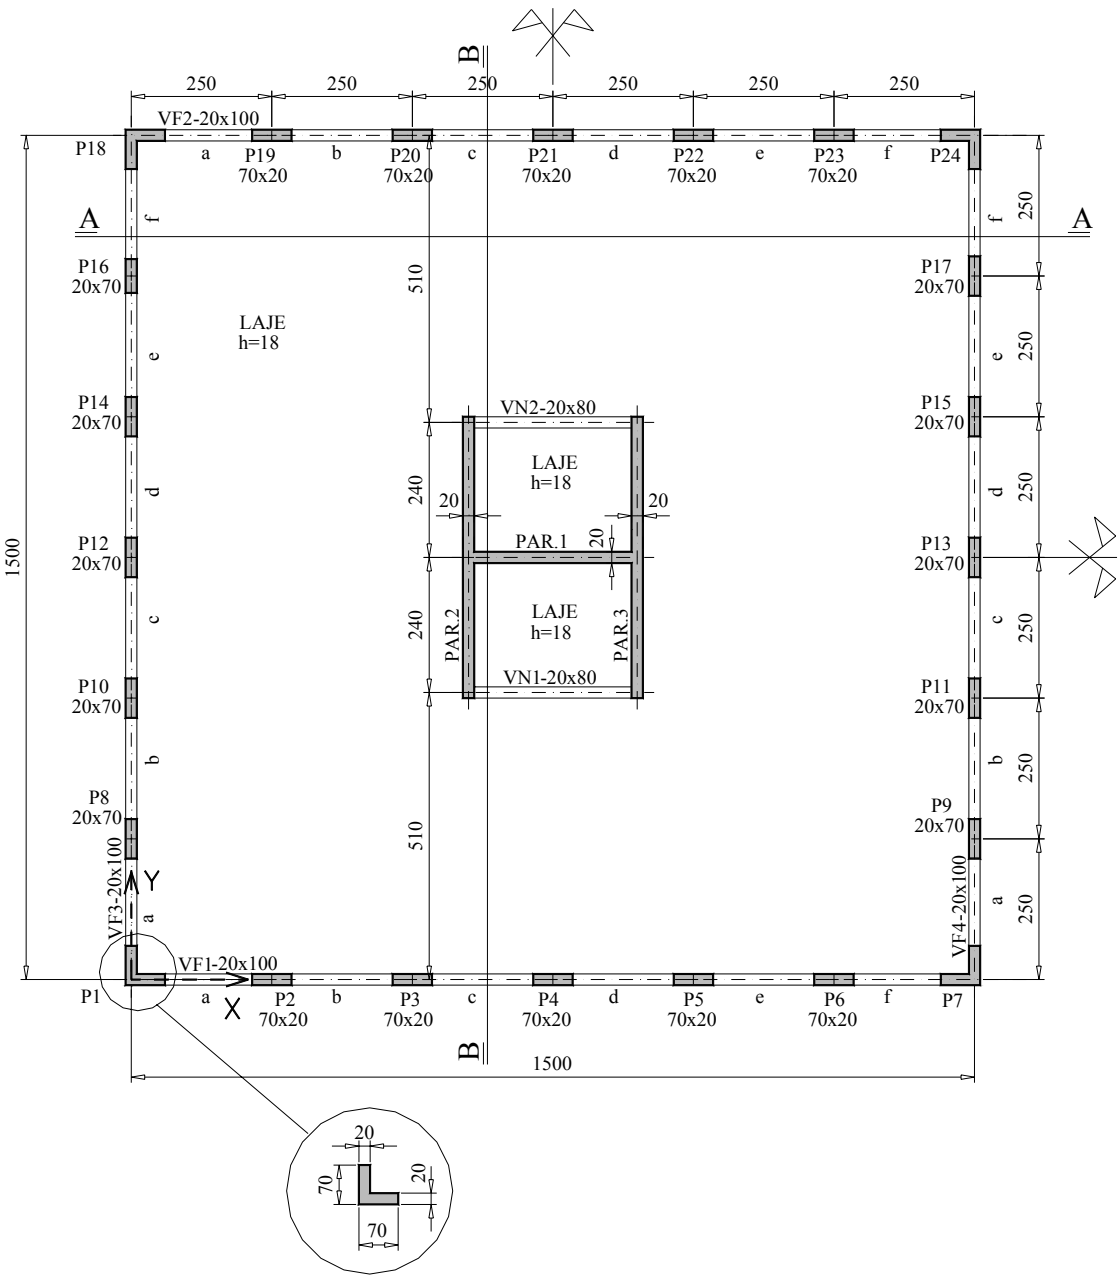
Planta do 30º andar (cotas em centímetros)
